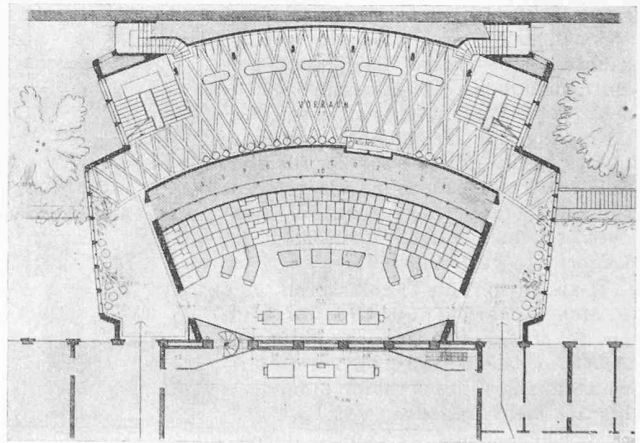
Neuer Hörsaal für Physik, Grundriss 1:500.
